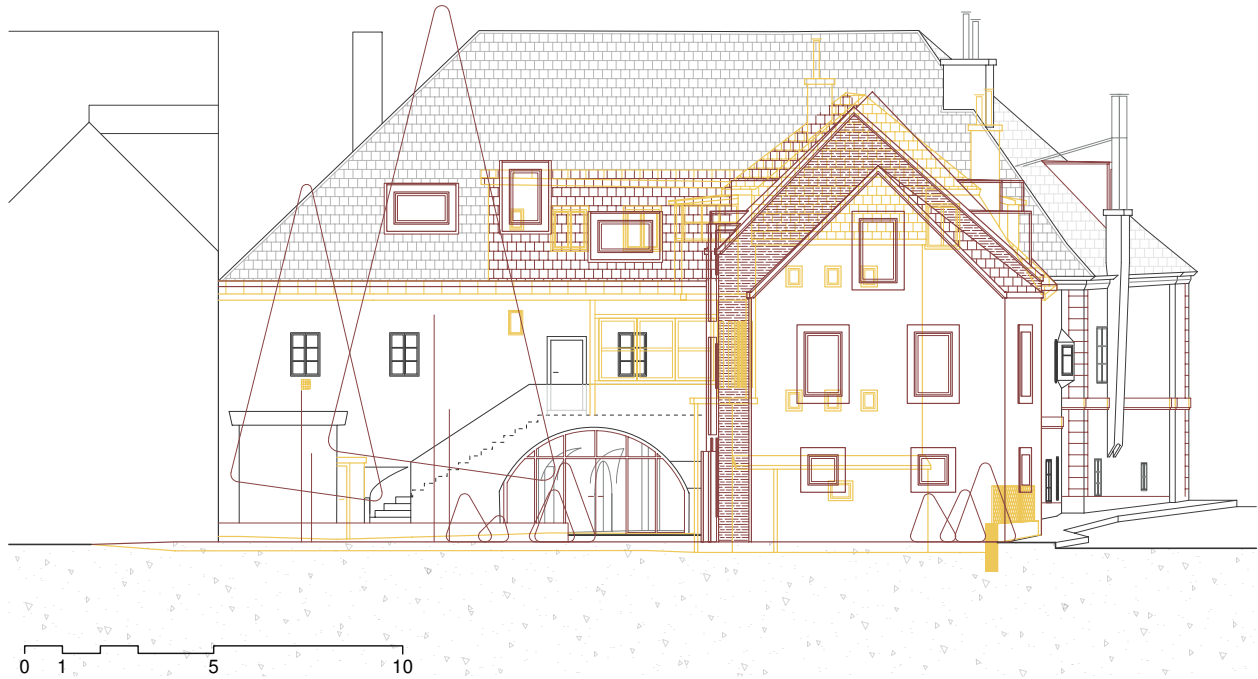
Bauliche Eingriffe Ansicht Ost M 1:200
